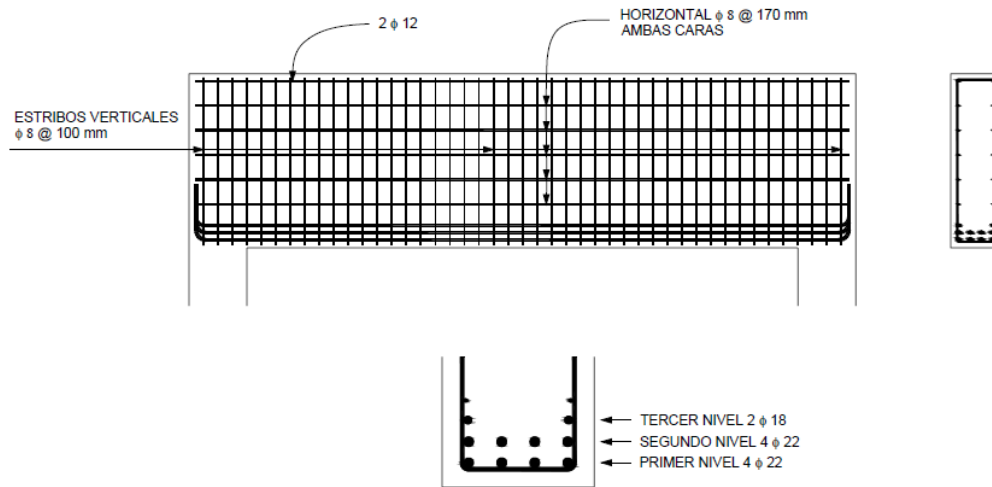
Armado del refuerzo de acero calculado según el diseño de la técnica puntal-tirante.
